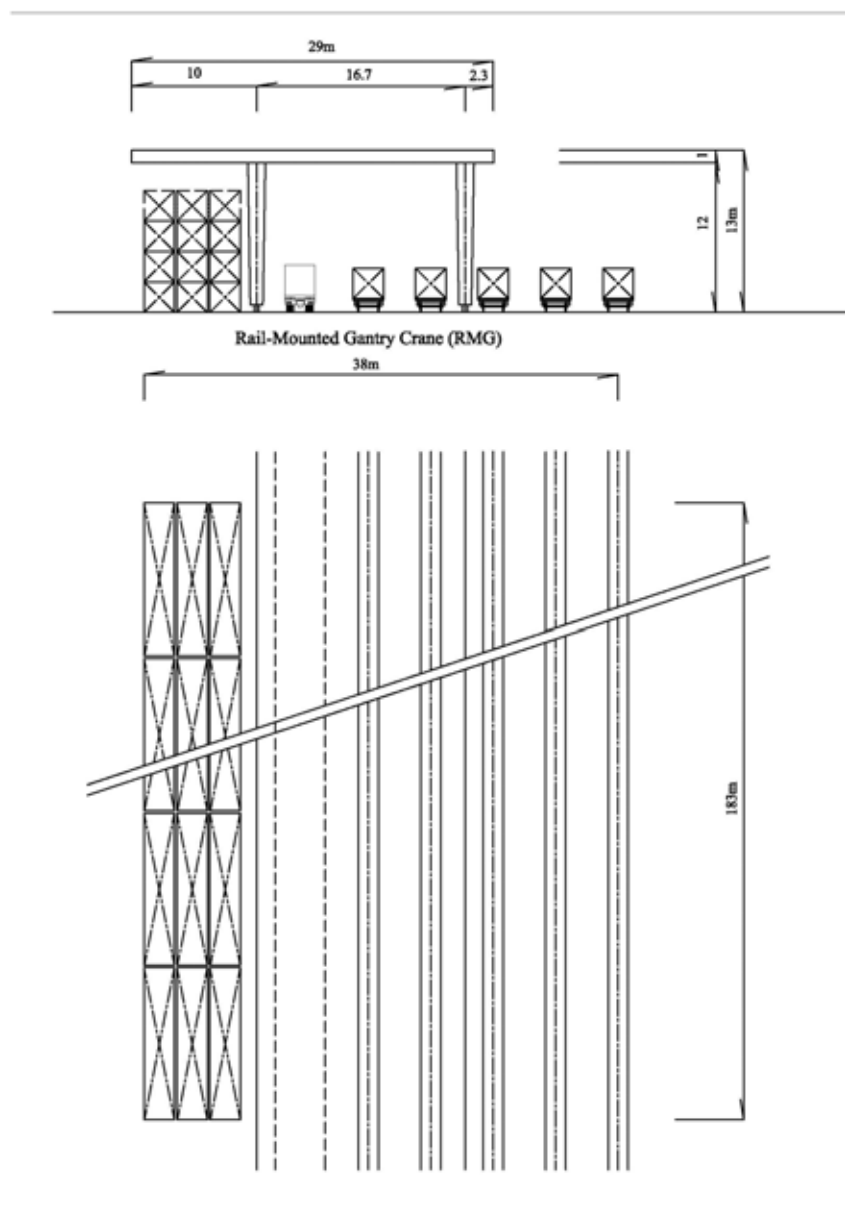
Planta de *Layout* das Instalações do Pátio Ferroviário de Contêineres
